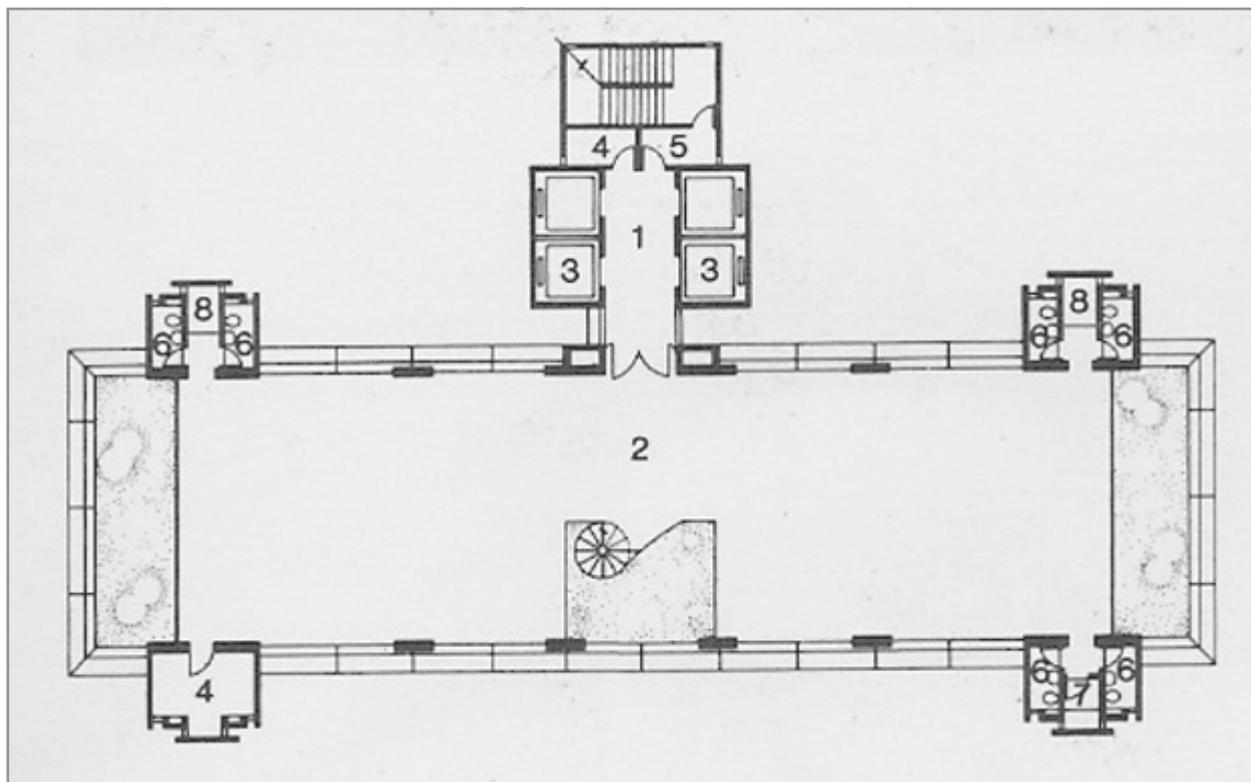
Planta do 7.º Pavimento - Fonte: Revista Projeto nº 110, Maio de 1988, página 91.
